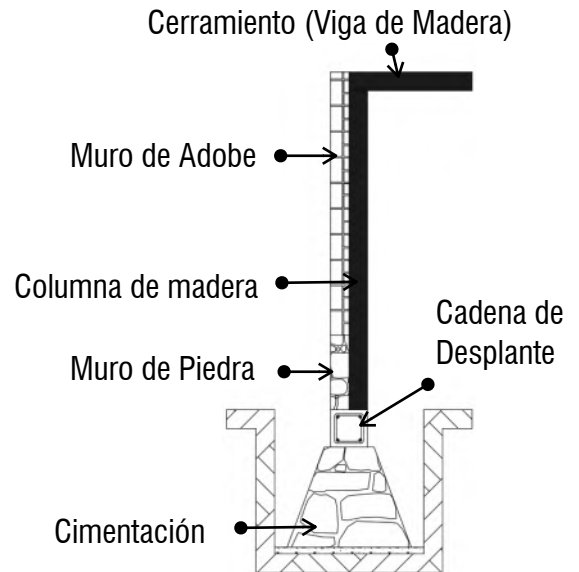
Corte de muro con refuerzos verticales y horizontales
